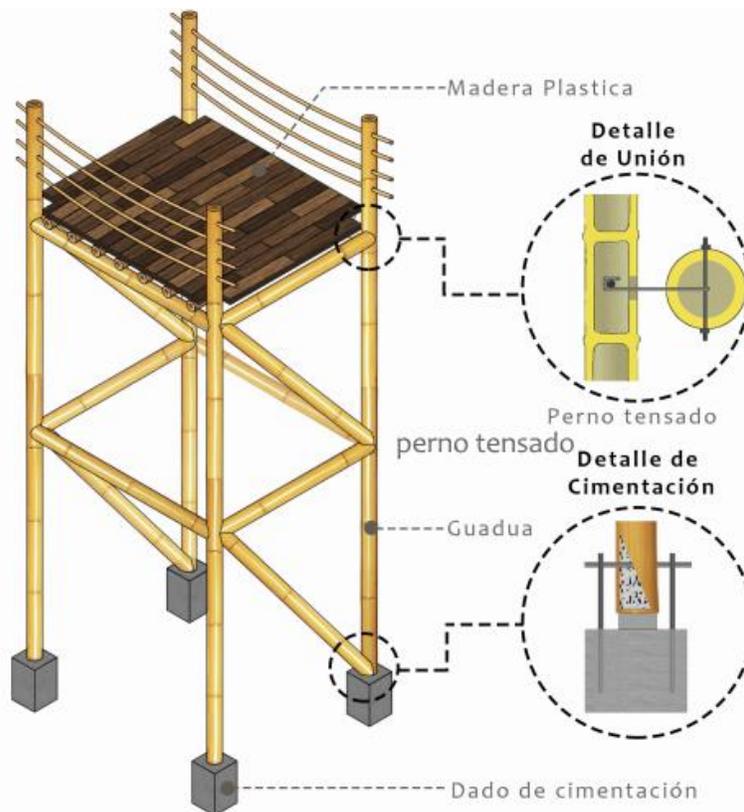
Estructura en guadua y detalles. Elaboración propia.
